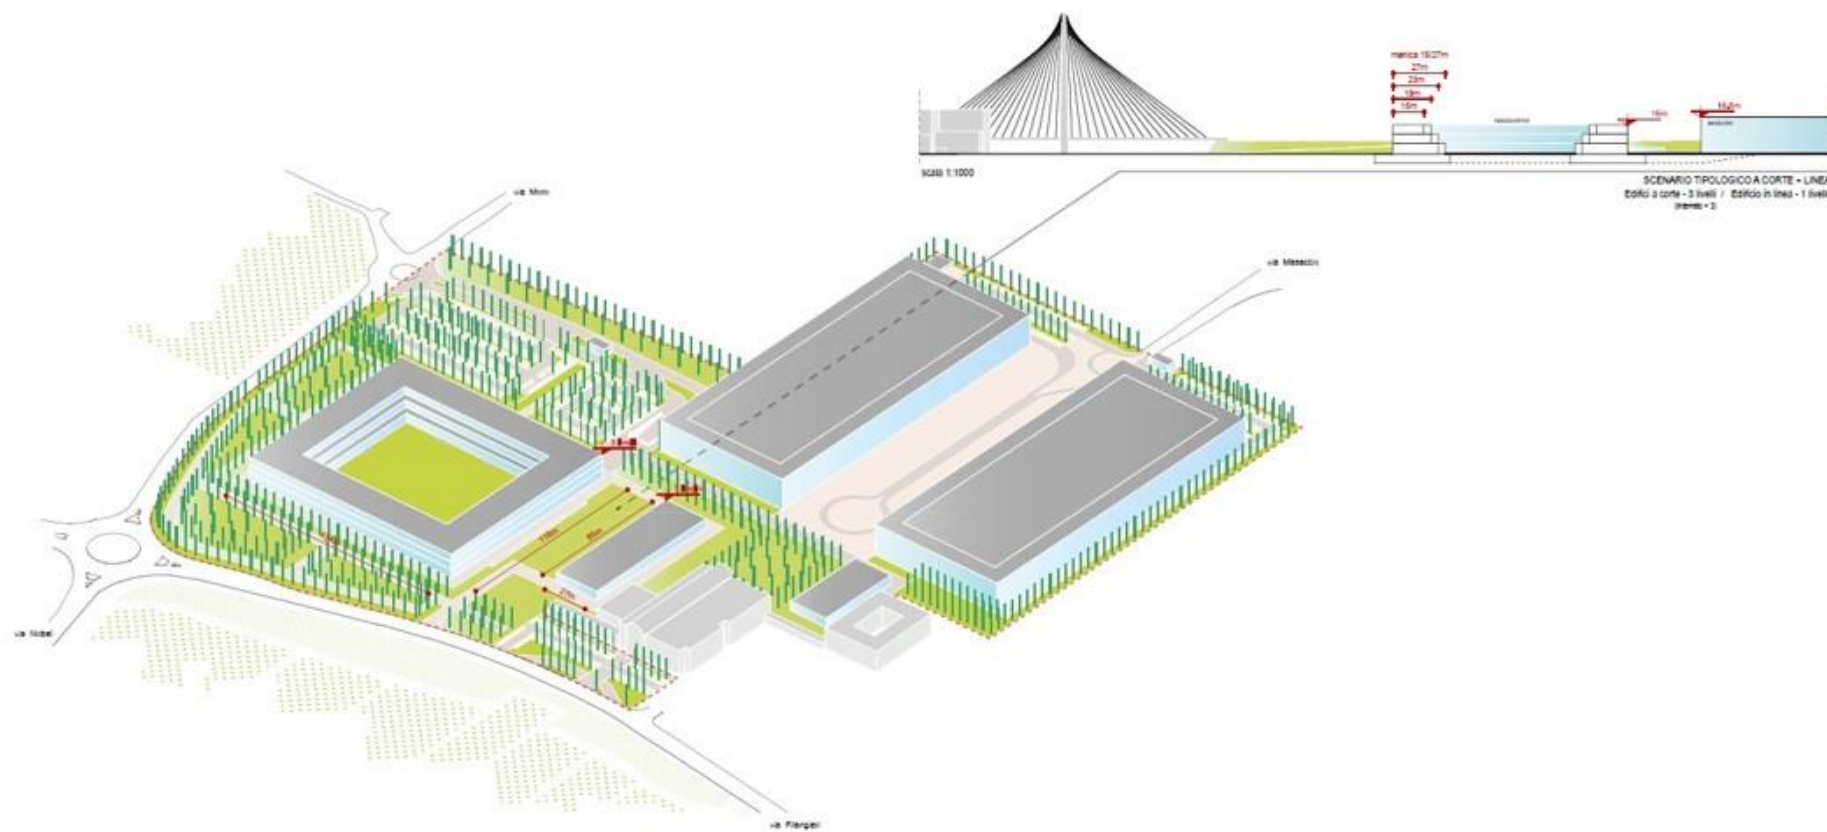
Stralcio elaborato 19.2 "Prefigurazione assonometrica_scenari planivolumetrici e profili di progetto"
